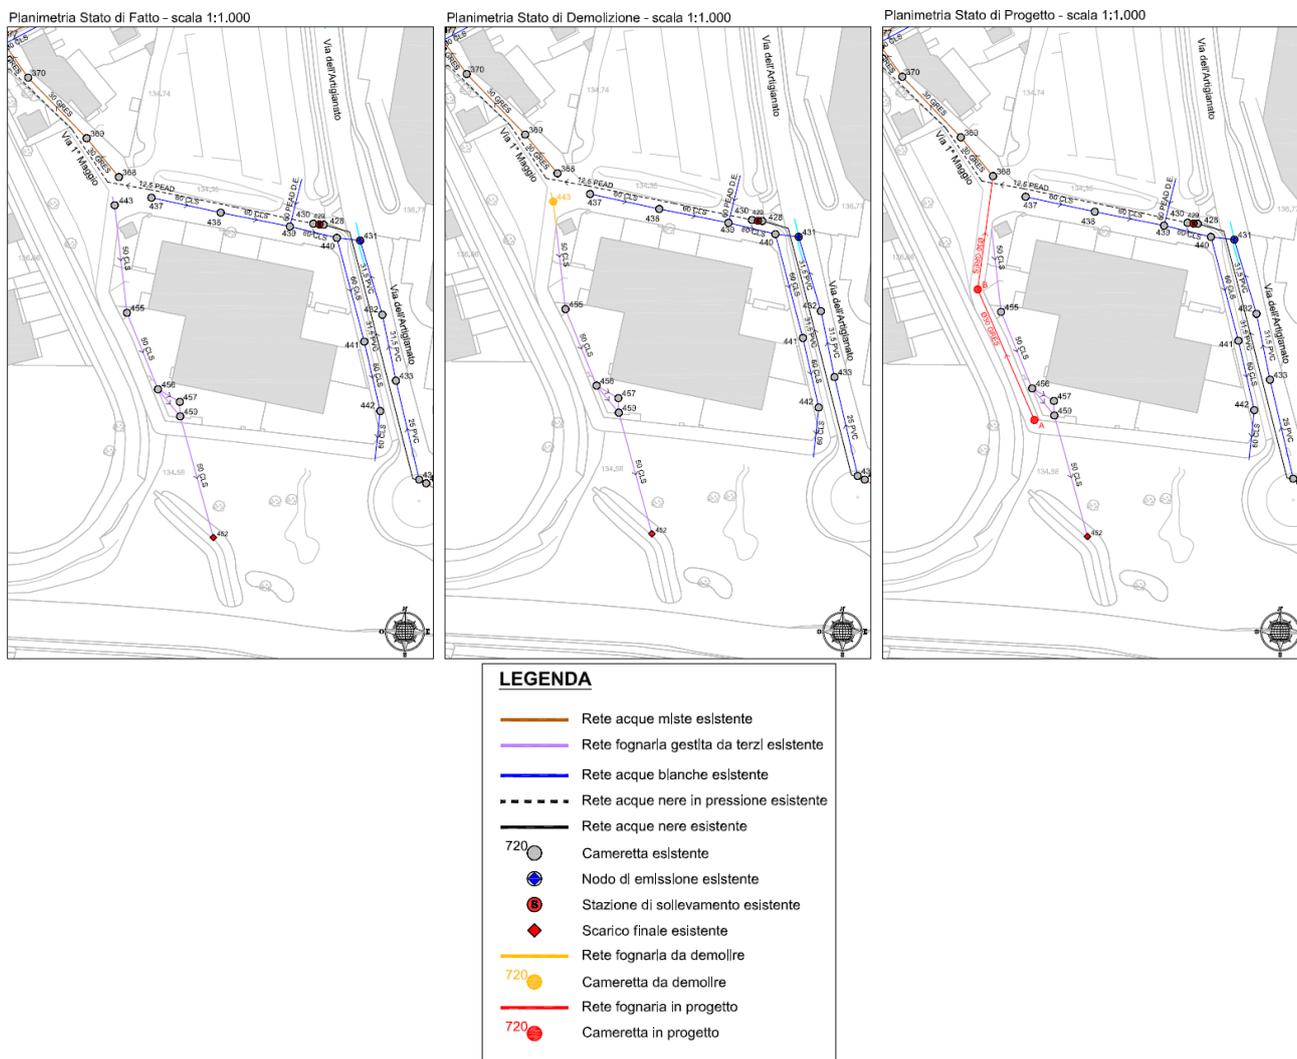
Planimetria stato ante-operam, stato di demolizione e stato di progetto (post-operam)
